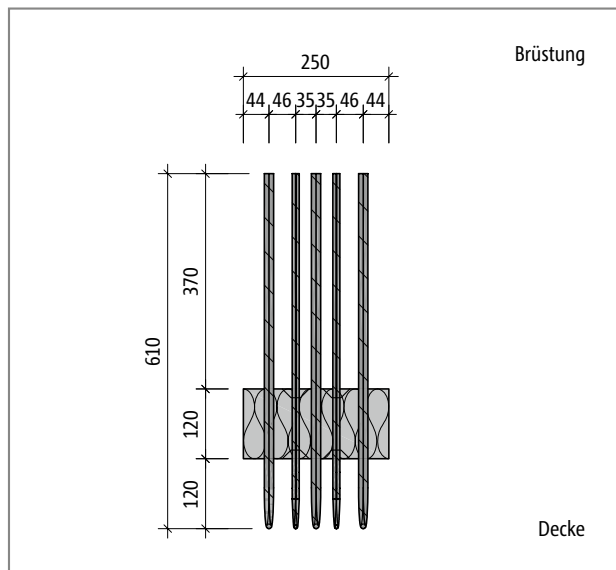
Schöck Isokorb® XT Typ AP: Produktschnitt
